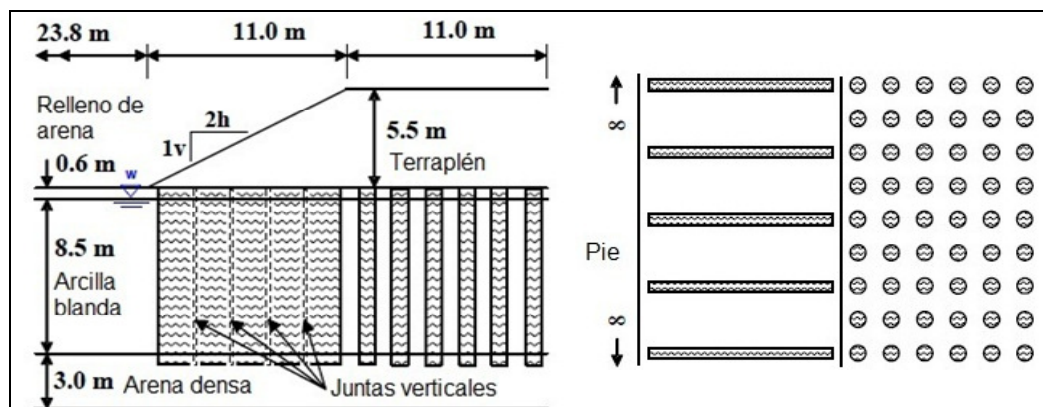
Sección y planta del terraplén sobre grupo de columnas DMM (adaptado de Navin y Filz, 2006).
